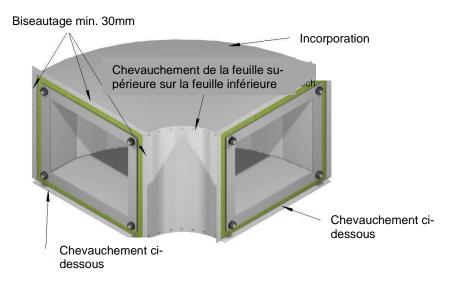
Habillage de coude de conduit horizontal <sup>2</sup>
